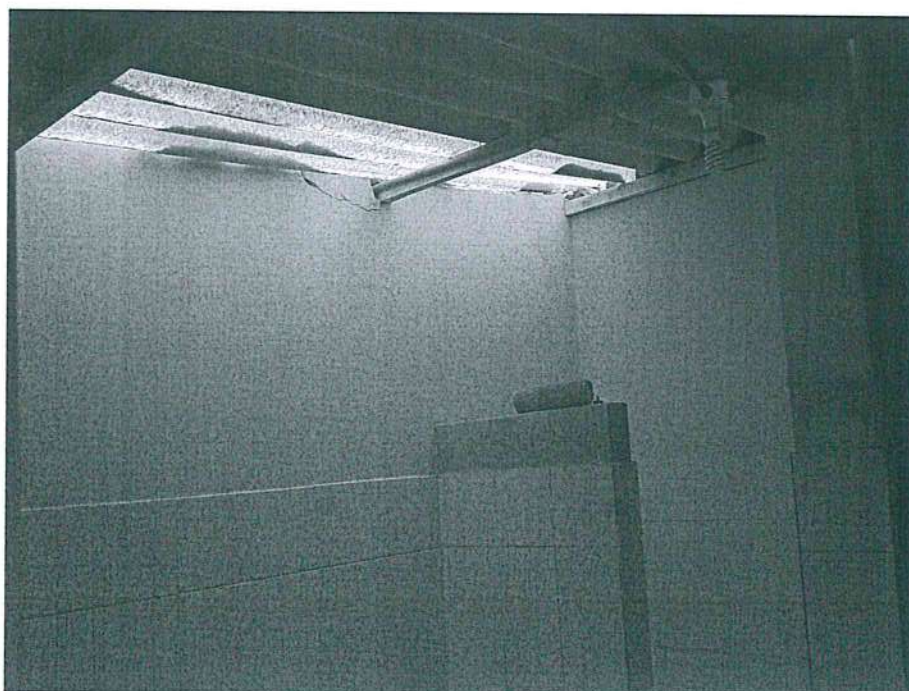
se tiene grietas longitudinales a nivel de anclaje de viga de madera y longitudinales entre unión de muros.
